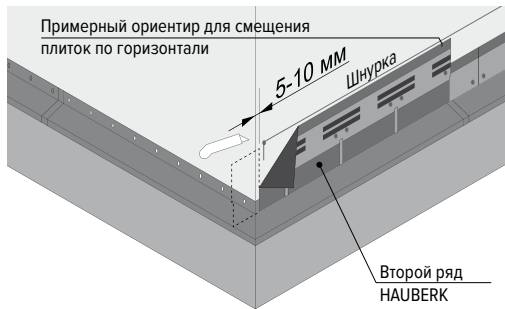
Монтаж первого и последующих рядов фасадной плитки
